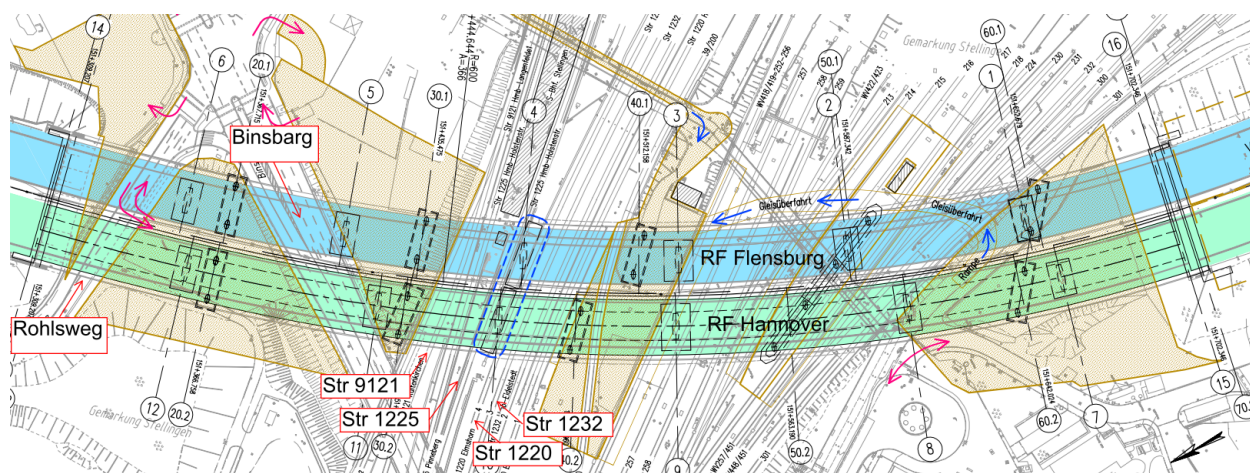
Übersicht Bestandsbauwerk und Pfeiler Neubau (© DEGES)
